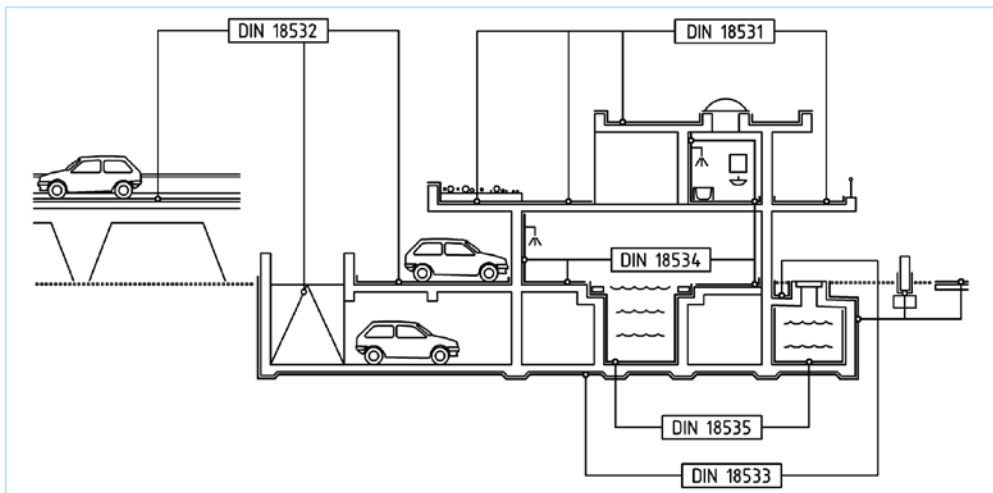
Anwendungsbereiche für Bauwerksabdichtungen nach der 1853er-Reihe [2]
